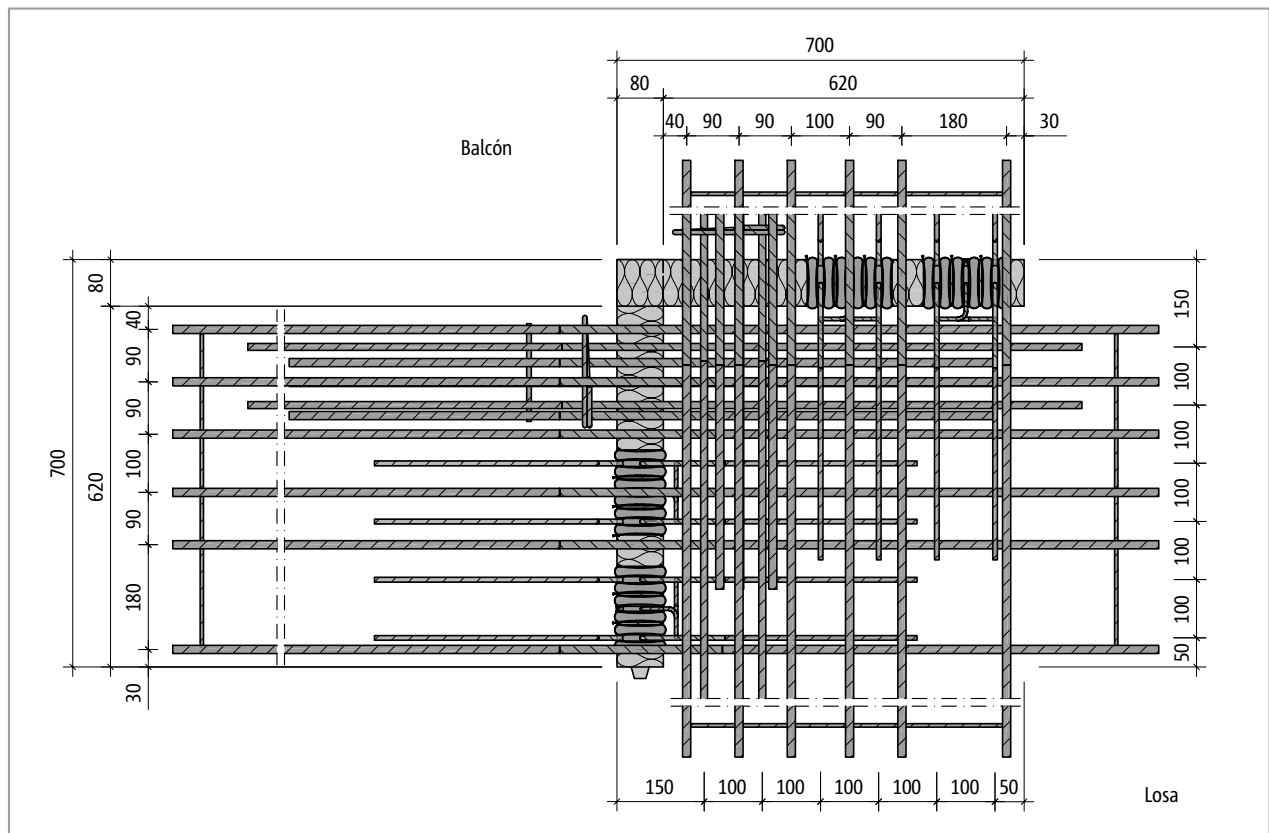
Schöck Isokorb® T tipo C-M3: Plano del producto
